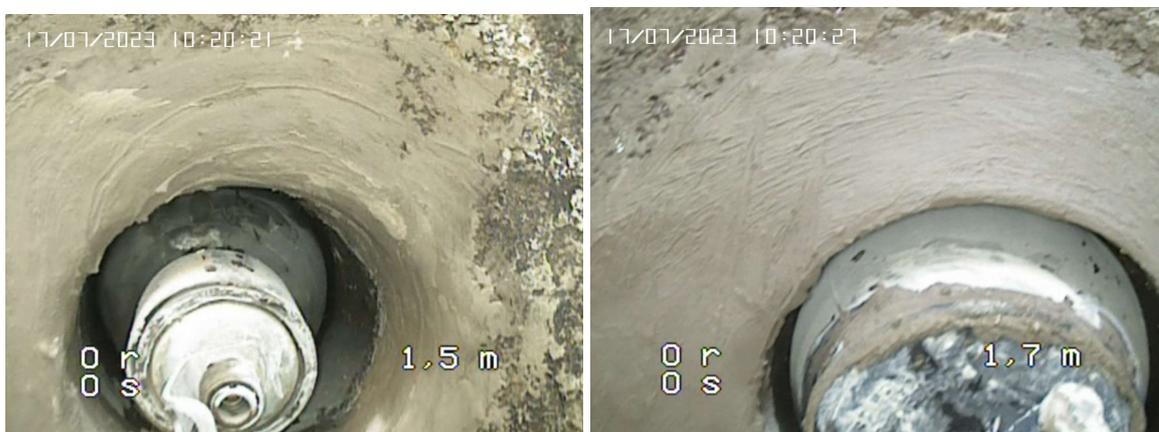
e foto 9: pozzo 122790 dopo risanamento
